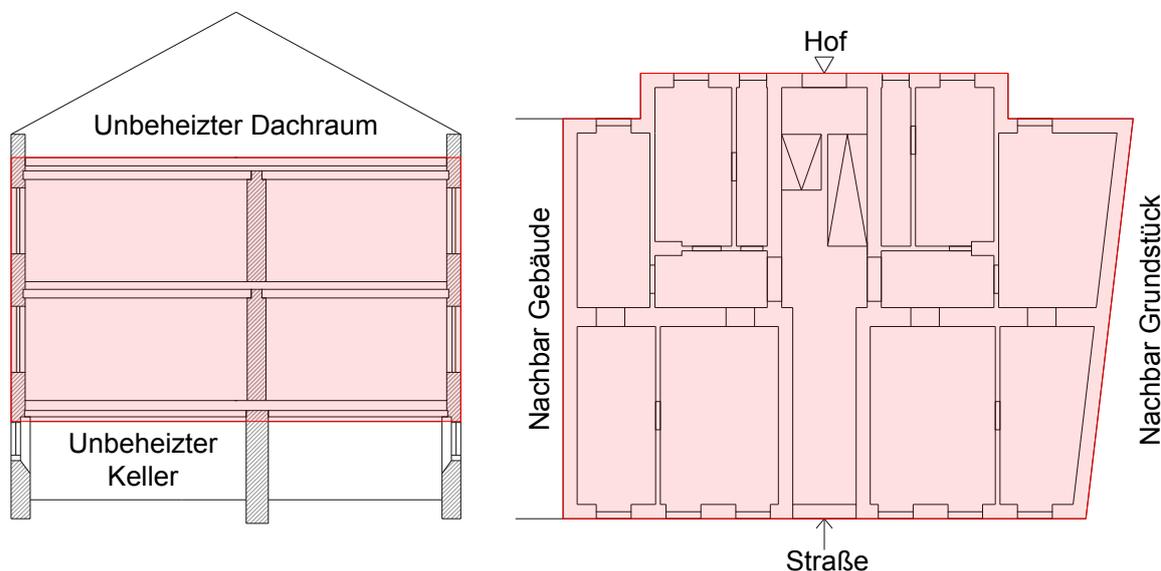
Gebäudehülle Gründerzeithaus Hadikgasse
